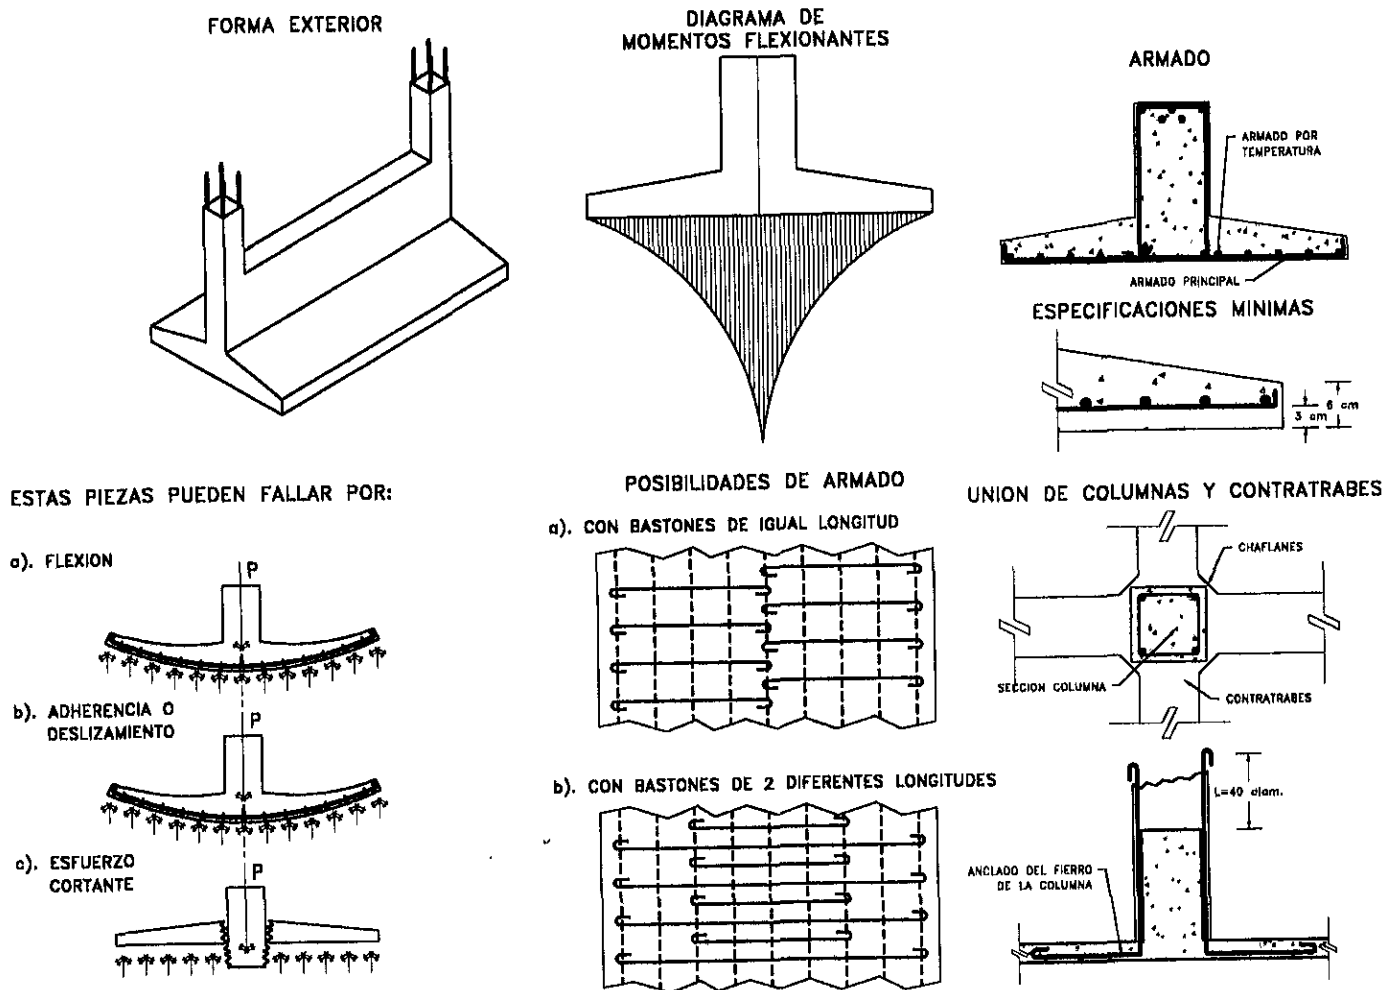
Cimientos de Zapata corrida en concreto armado.
